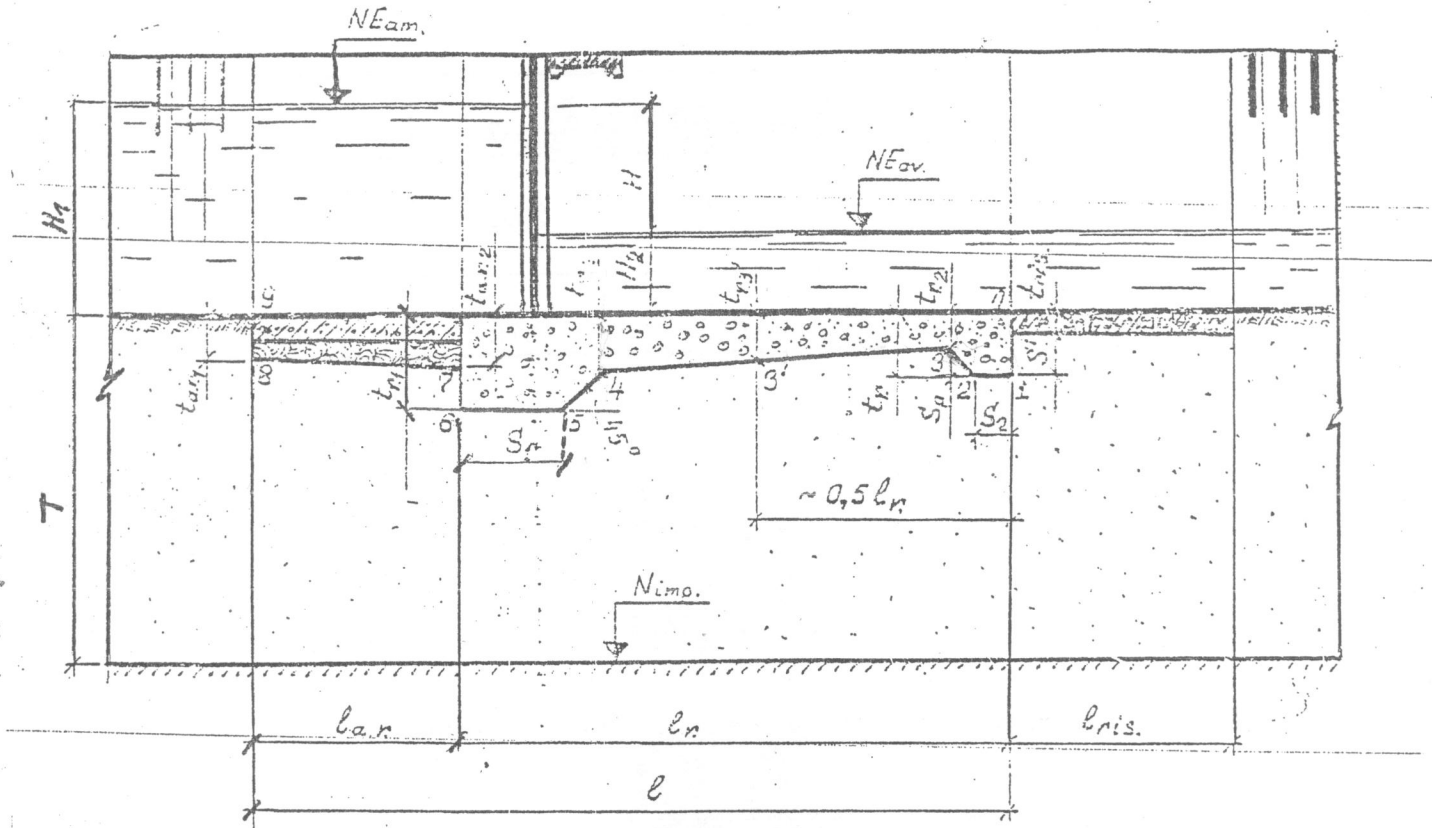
Coupe longitudinale d'un ouvrage régulateur
